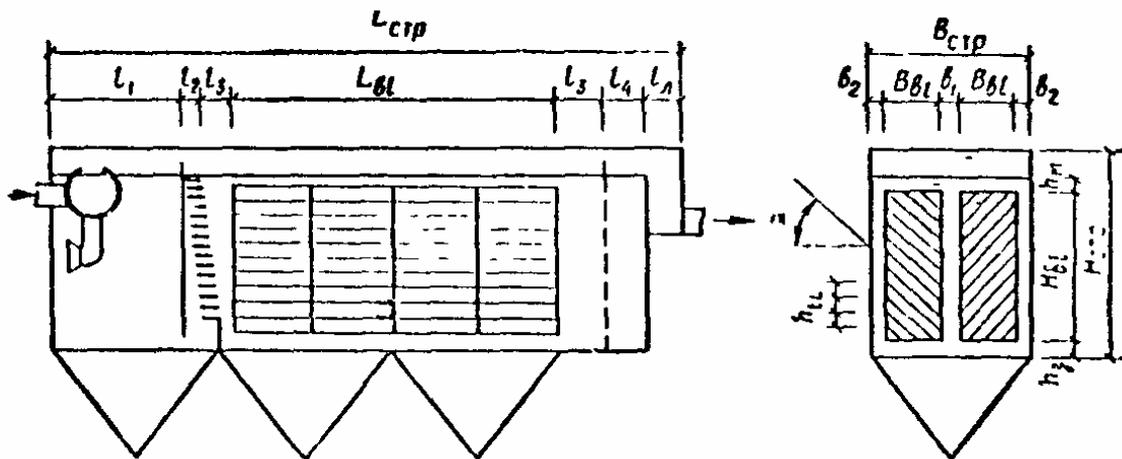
Схема тонкослойного отстойника, работающего по перекрестной схеме удаления осадка
